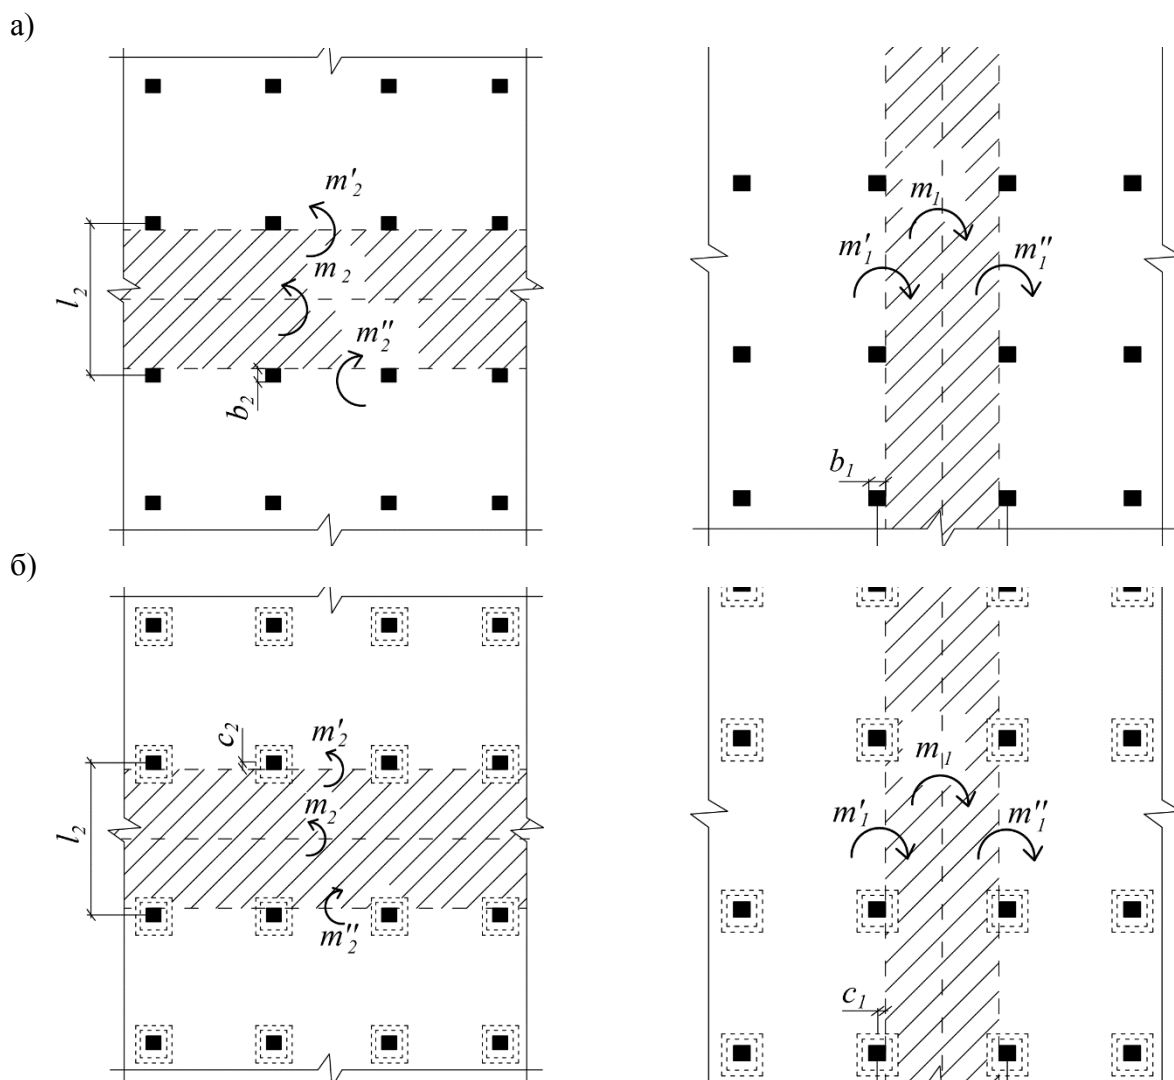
Расчетные схемы безбалочного бескапительного (а) и капитального (б) перекрытия при полосовом изломе панелей вдоль и поперек перекрытия
